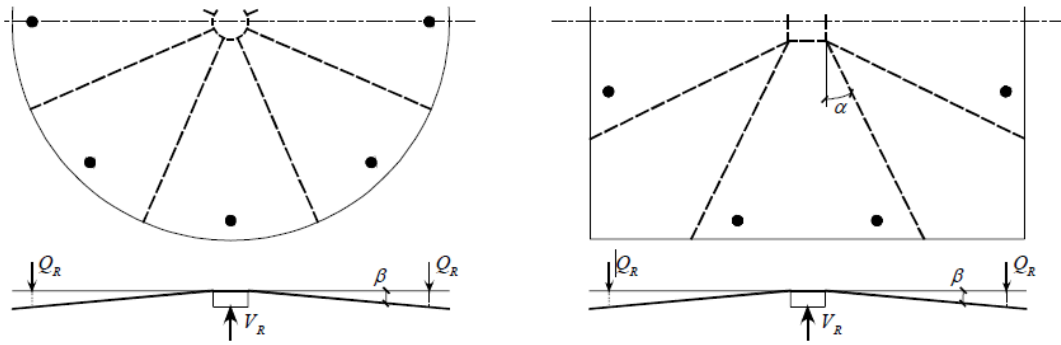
Linhas de rotura numa laje circular e numa laje quadrada de betão armado [3]
